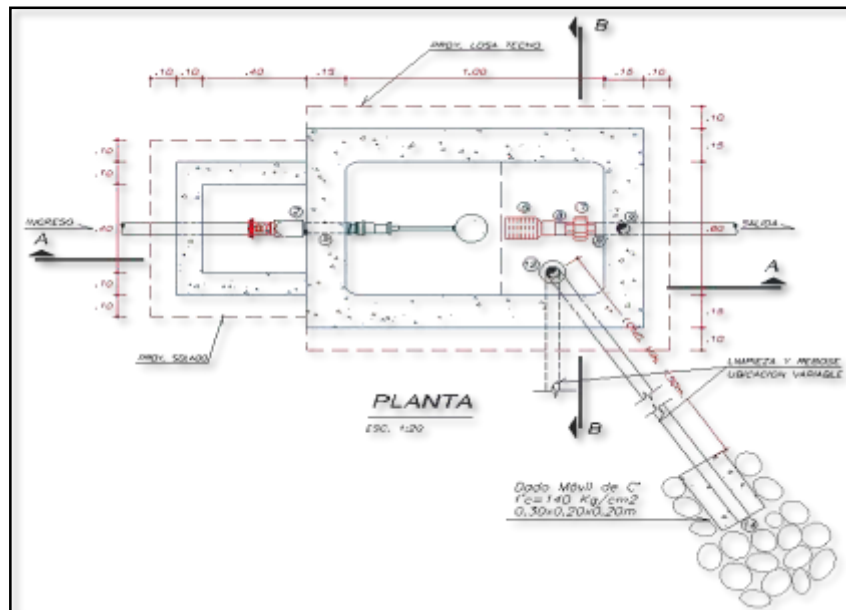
Vista en planta de cámara rompe presión 7 – CRP7
